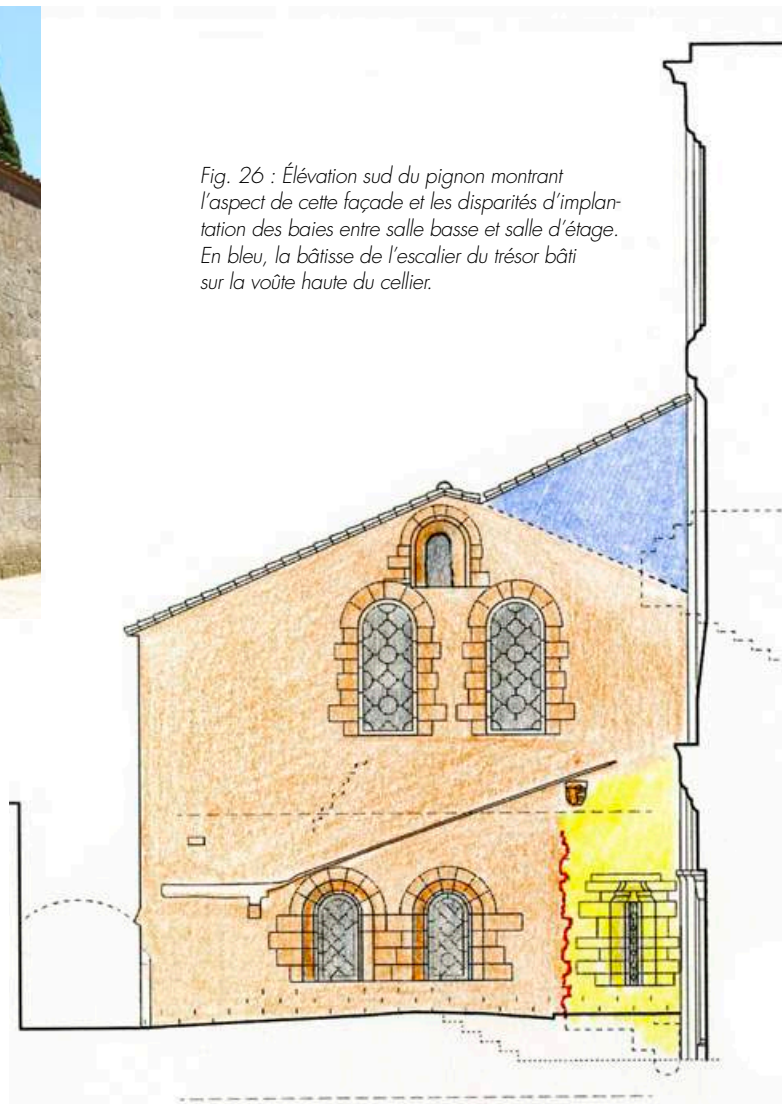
Élévation sud du pignon montrant l'aspect de cette façade et les disparités d'implantation des baies entre salle basse et salle d'étage. En bleu, la bâtisse de l'escalier du trésor bâti sur la voûte haute du cellier.
